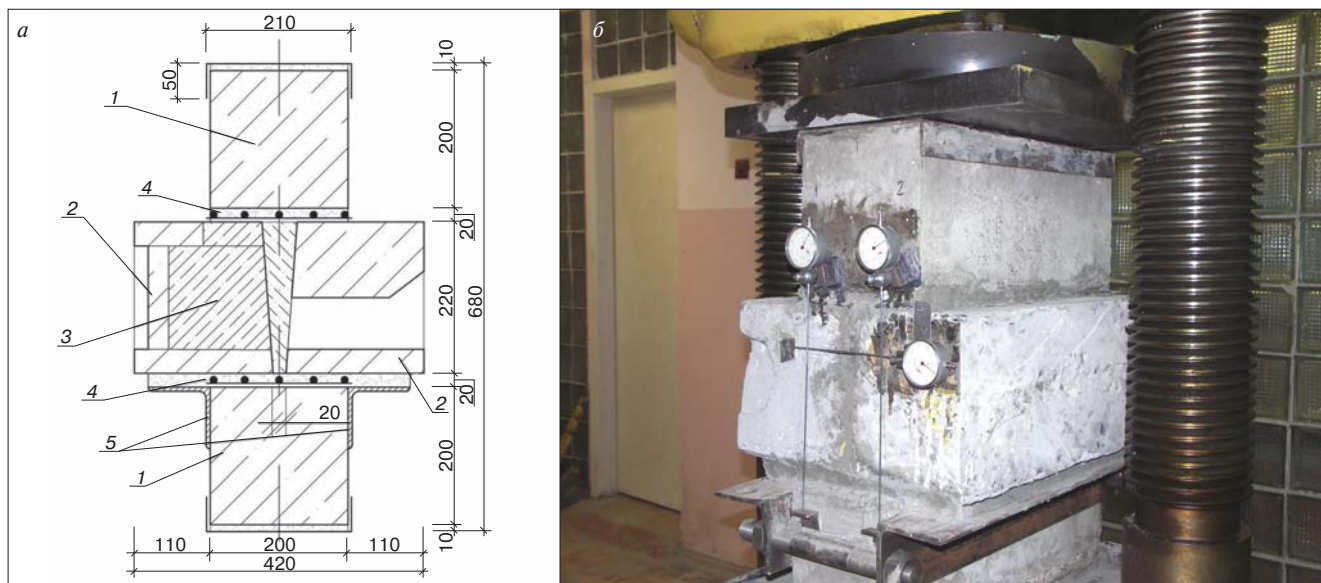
Общий вид испытания (а) и фрагмента (б): 1 – бетонная призма; 2 – фрагмент плиты перекрытия; 3 – бетонный вкладыш; 4 – армированный растворный шов; 5 – поддерживающие конструкции
